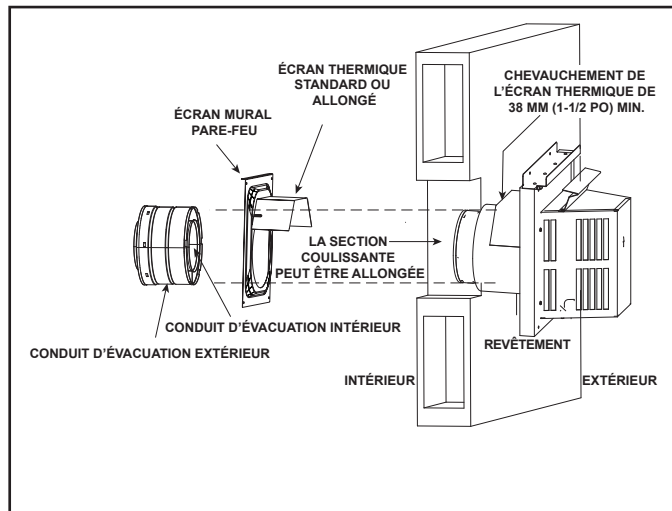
Conduit d'évacuation traversant le mur - PVI-SLP
